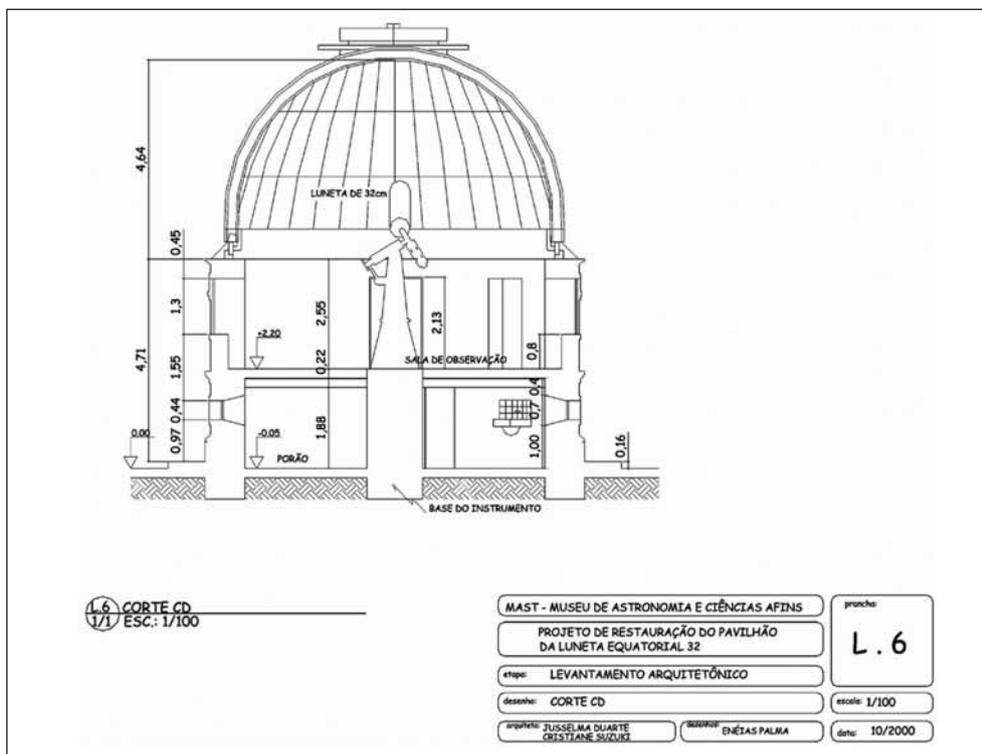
Planta de corte do pavilhão de estudo (CD).
